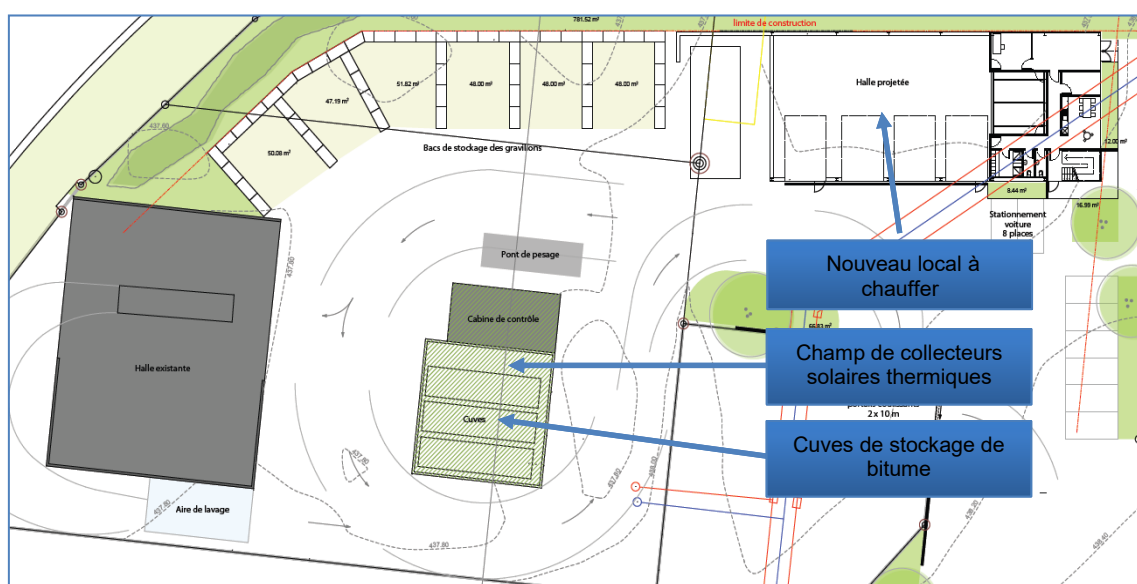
site COLAS à Pittet-Châtelan avec positionnement de l'installation solaire
